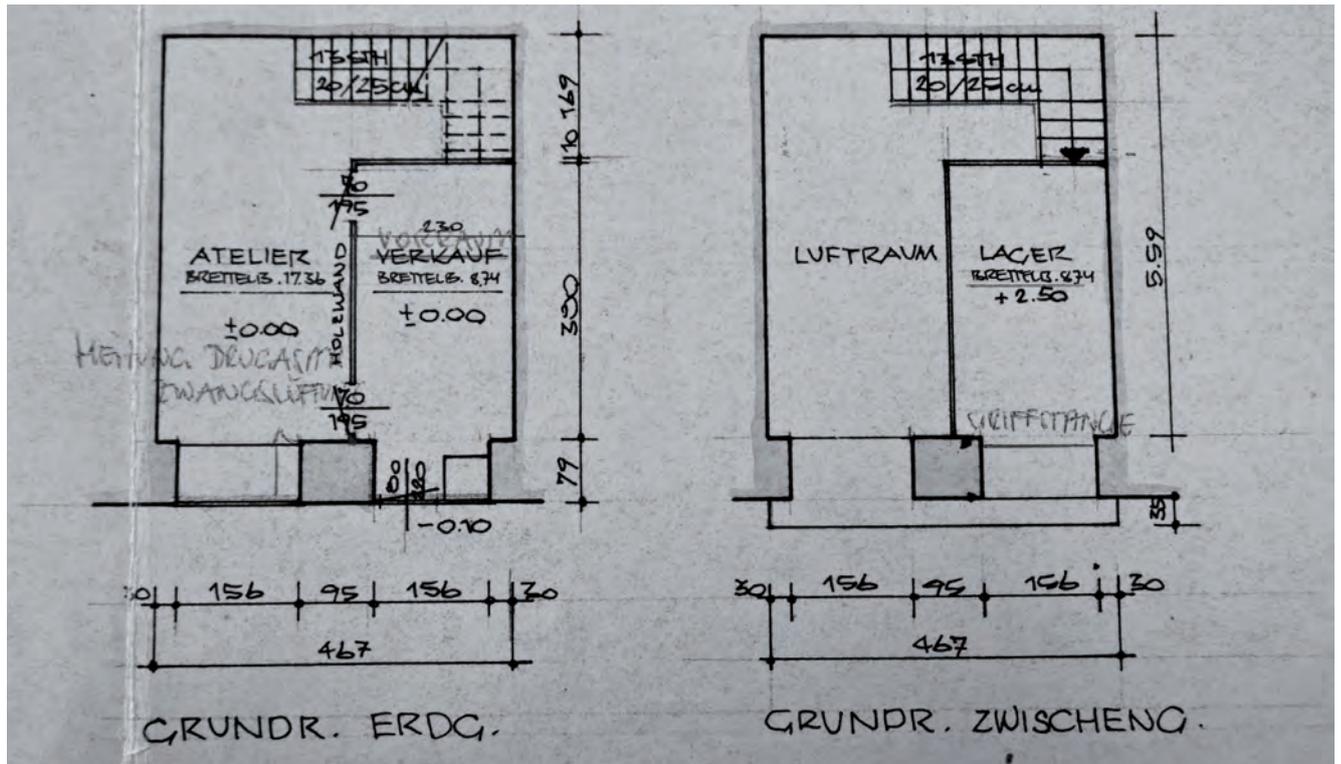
Grundriss EG und Zwischengeschoss Juwelier Berthold
